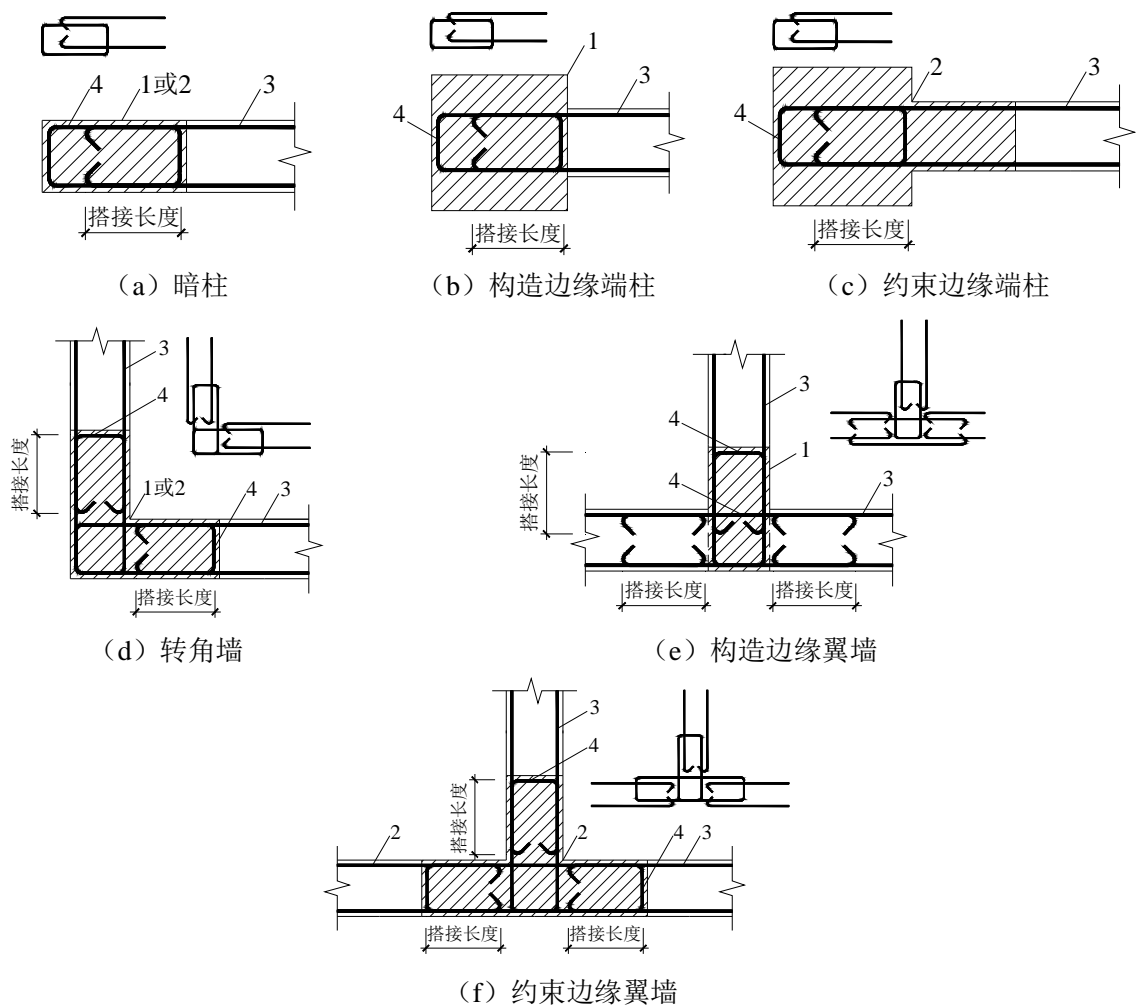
固模剪力墙端部、洞口两侧及纵横墙交接处墙体水平钢筋构造示意
